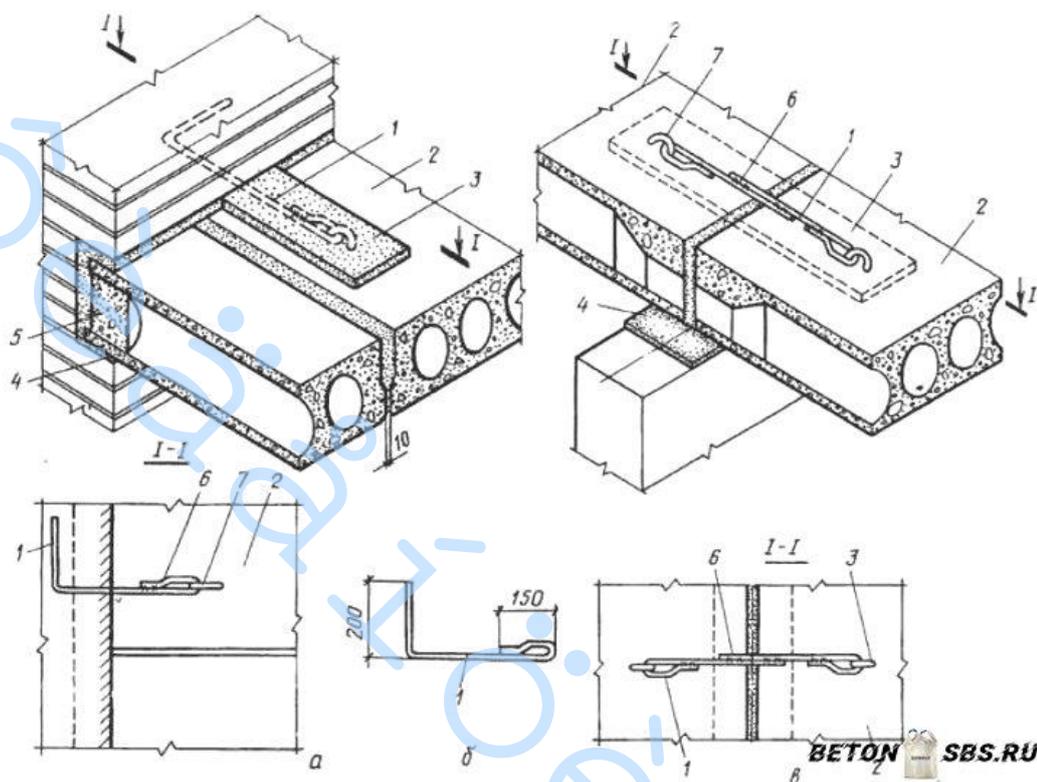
Сборные железобетонные перекрытия с многопустотными плитами типа ПК:
